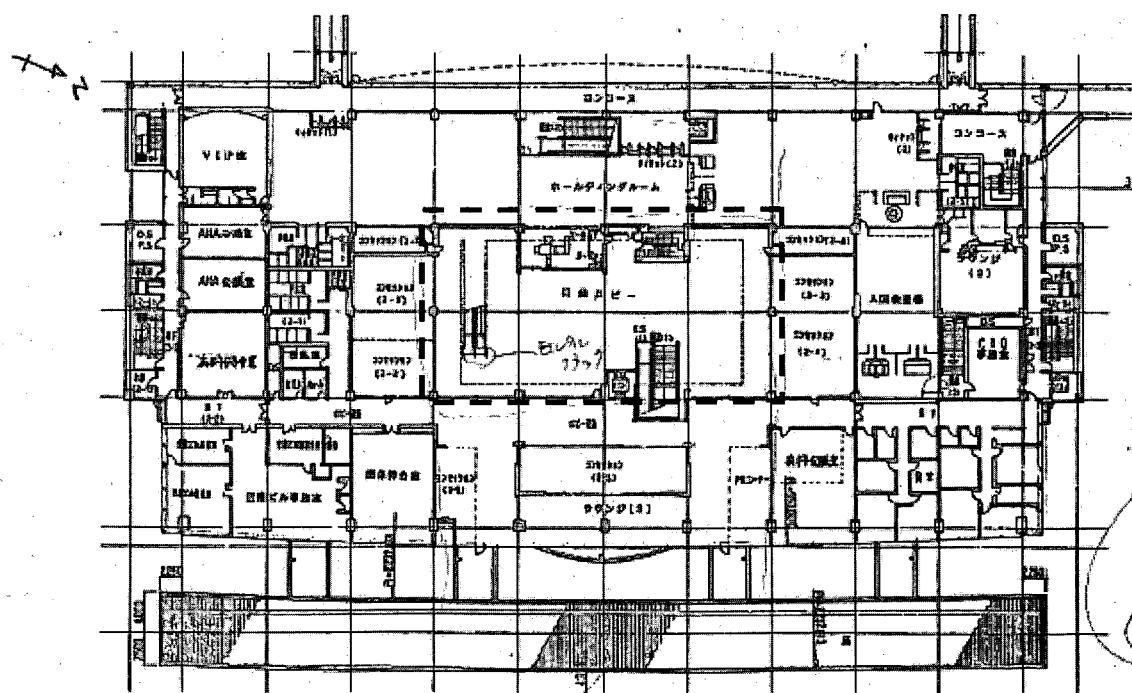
2 階平面図 (調査当日の配布資料^{※3}より)
